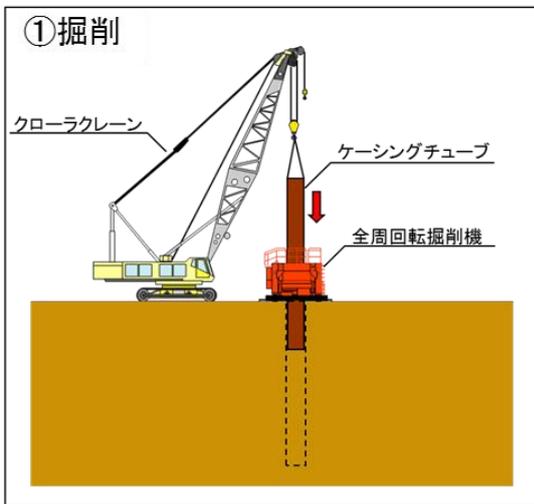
下部工（場所打ち杭基礎形式）の施工手順
